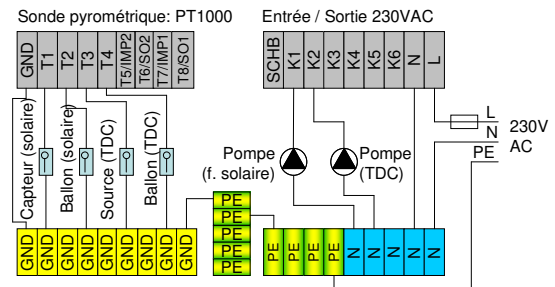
Schéma (0.3) 1F1S1WW, plan de connexion
